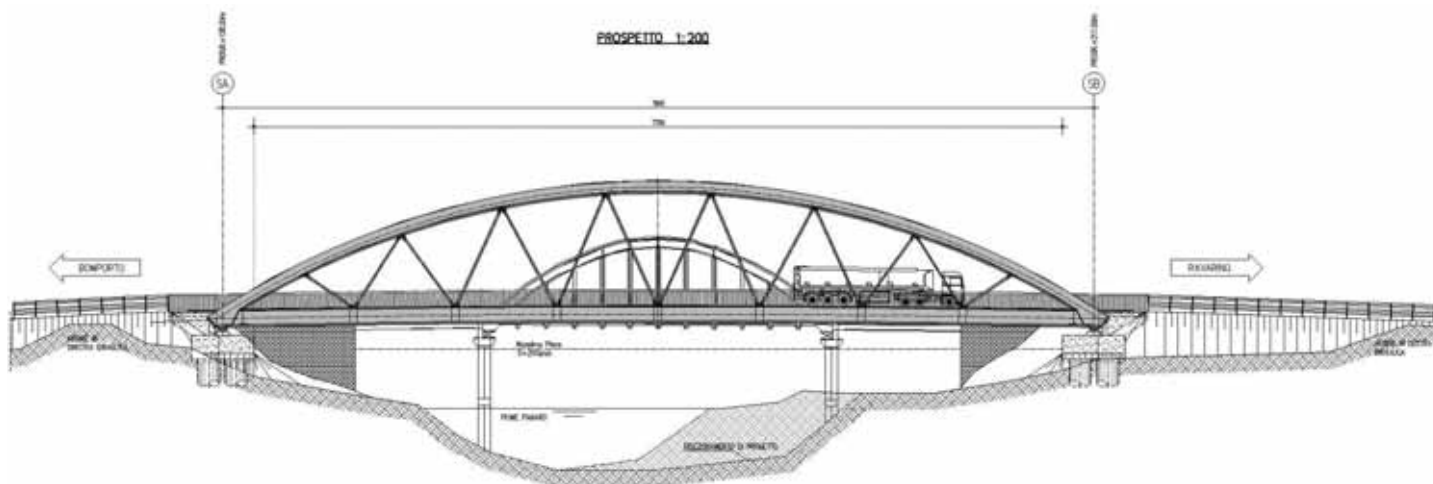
Prospetto (sovrapposizione ponte esistente e ponte nuovo)
